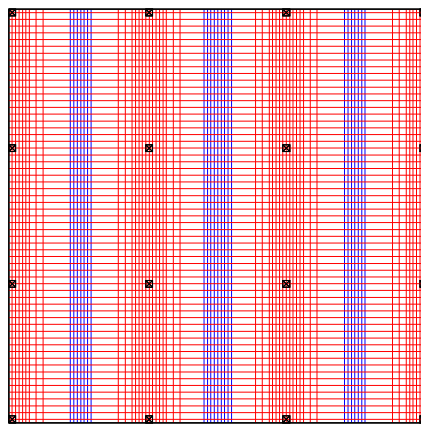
Alternativa de traçado 4 dos cabos no pavimento sem balanço
